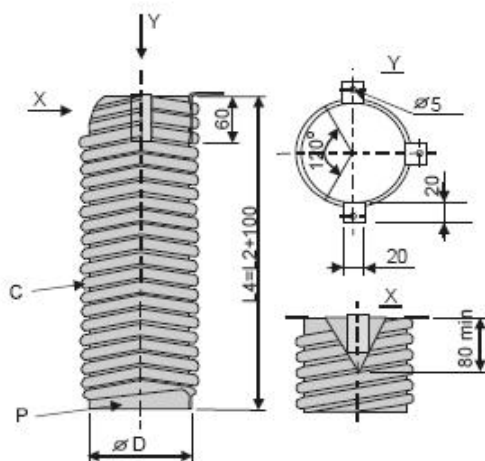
Фундаментное гнездо с использованием гофрированной тали стандарта SFS 4632. На рисунке отмечены фундаментное гнездо (C) и опорная пластина (P).
